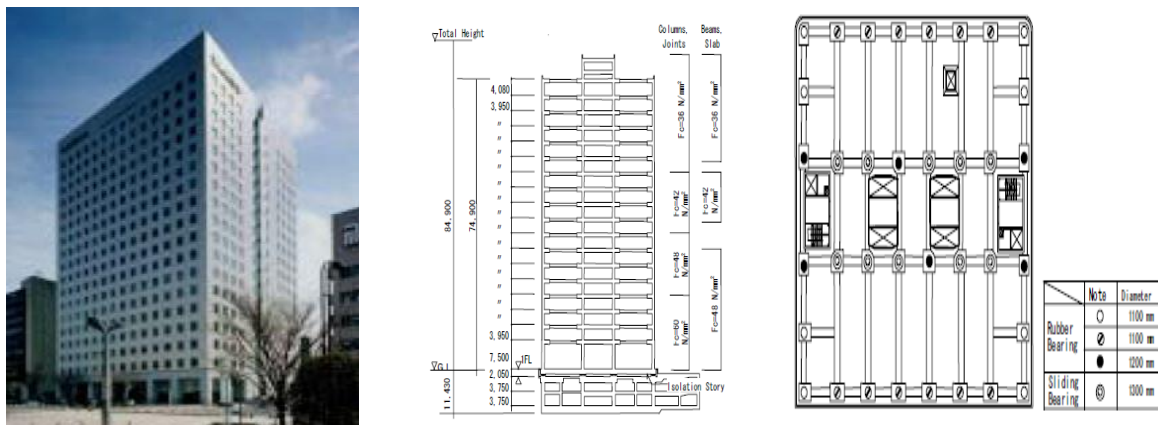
Vue en plan et en élévation du SENDI MT BUILDING.
